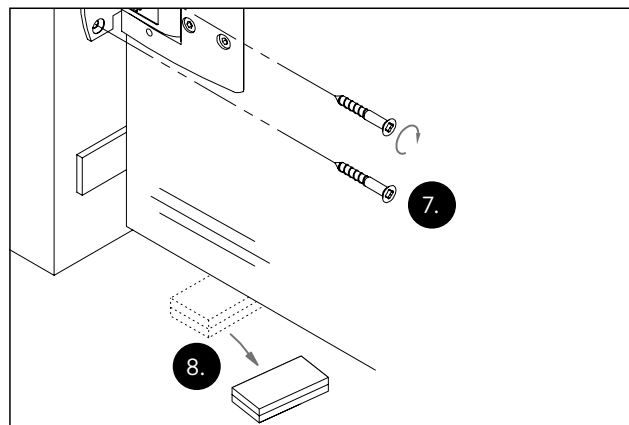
Montage des paumelles à rappel de porte battante sur le mur
